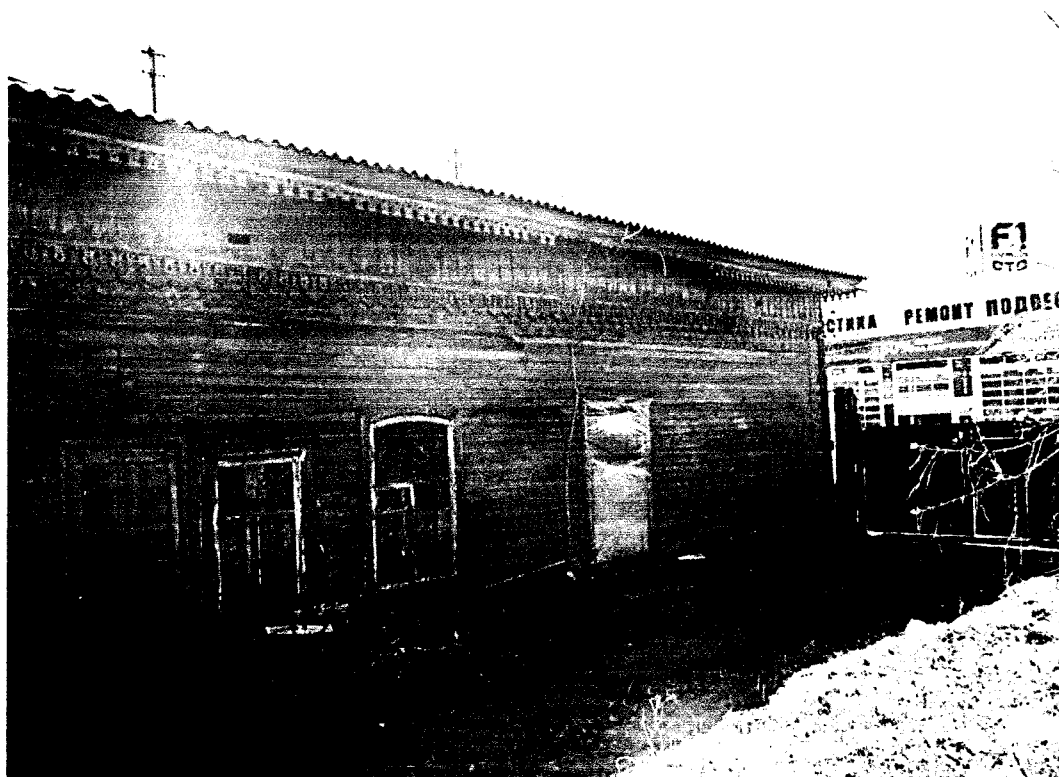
Боковой (северо-западный) фасад здания лечебницы (лит.А, А1, А2).
